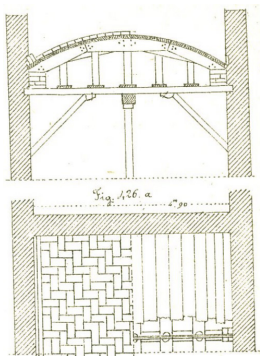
Exemplo de disposição dos tijolos na construção duma abobadilha tipo alentejana com emprego de cimbra para posterior vazamento de argamassa: corte (em cima); planta (em baixo) (Lenti 1884)
